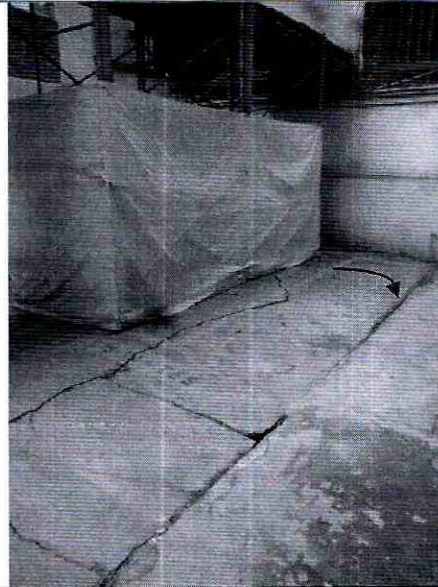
Presencia de fisuras en muros de cerramiento de la portería del Conjunto Residencial La Esperanza I y II P.H. de la Calle 163B No. 45 - 32, en el Sector Catastral Britalia de la Localidad Suba.
